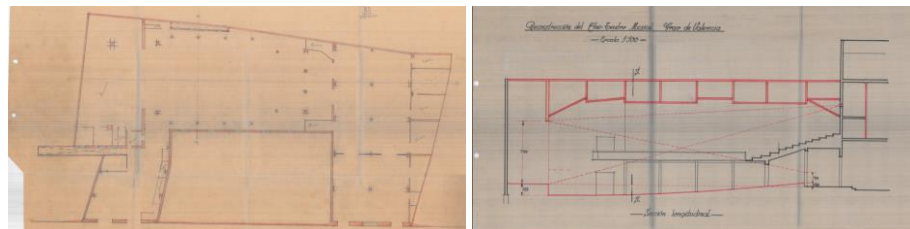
01 Planta anterior a la intervención Joaquín Rieta. 02 Sección longitudinal del proyecto
